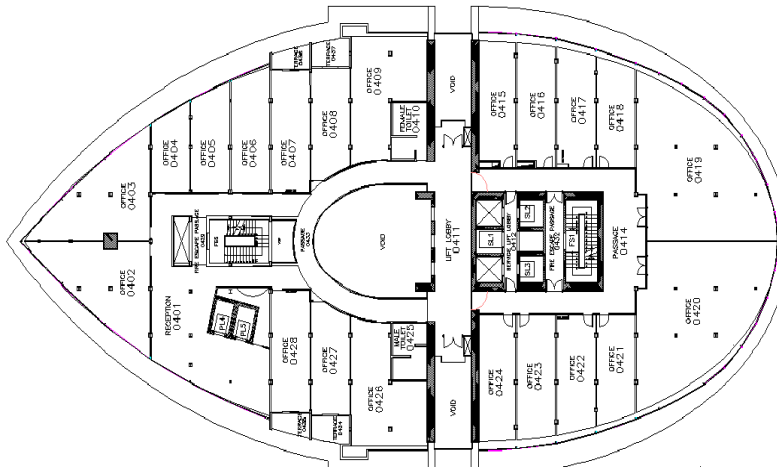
مسقط افقي للطابق الاول
